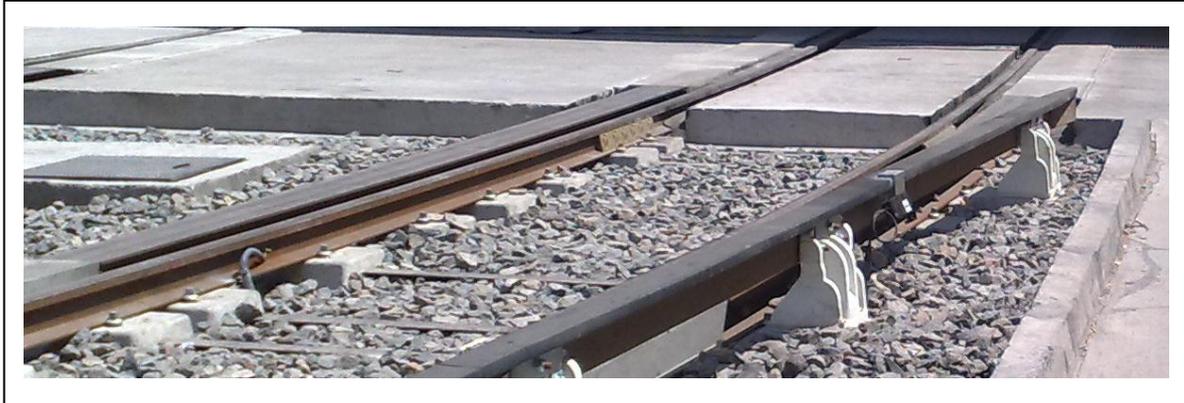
Pista metálica antes del ingreso a pasillo de hormigón.
